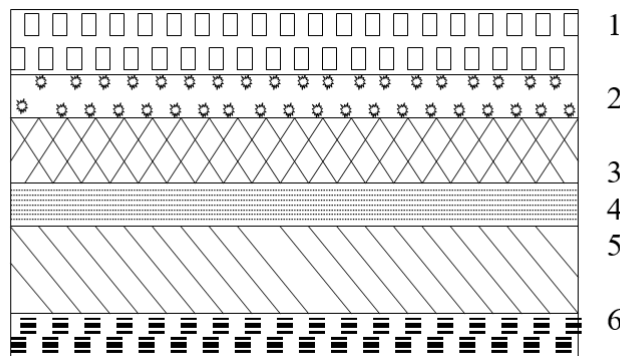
Coupe verticale du plancher courant (dalle pleine)
